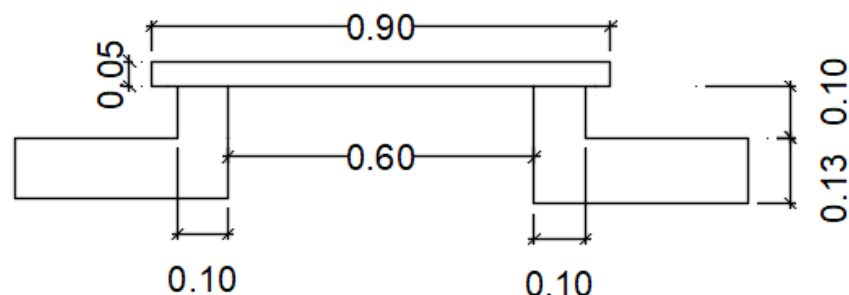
Detalhamento das tampas das caixas de inspeção.
